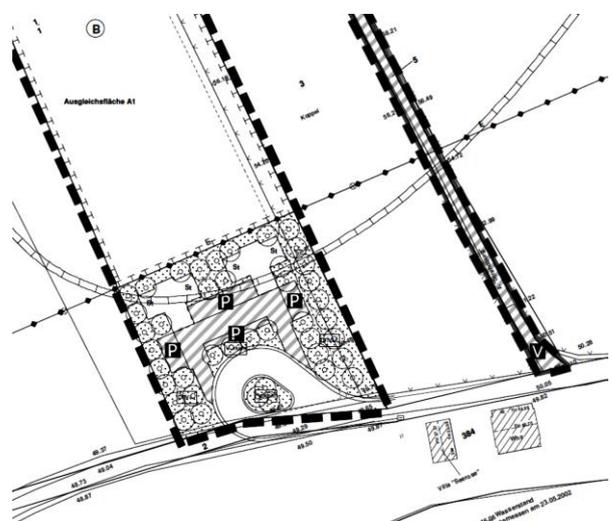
Bebauungsplan Nr. 2/2002 "Strandburg", Ausschnitt ohne Maßstab
